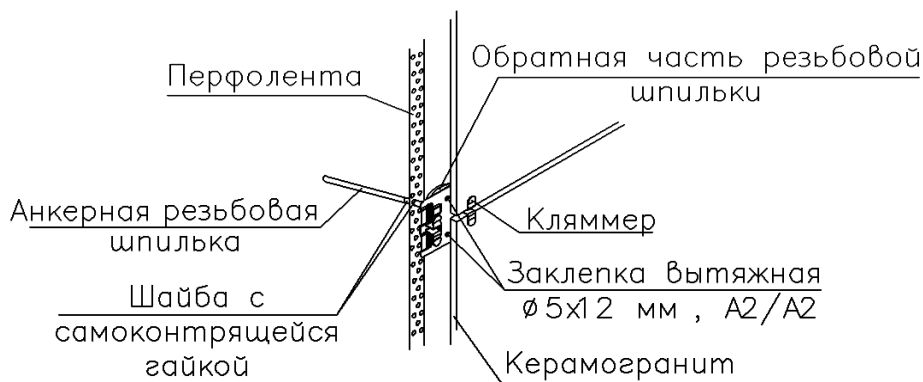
Крепление облицовочных плит в месте установки анкерной резьбовой шпильки
